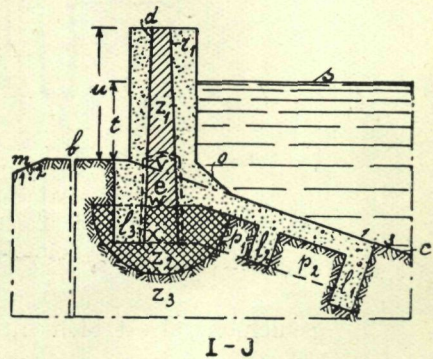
Croquis d'une coupe verticale d'un joint (voir coupe *i-j*, fig. 26).
